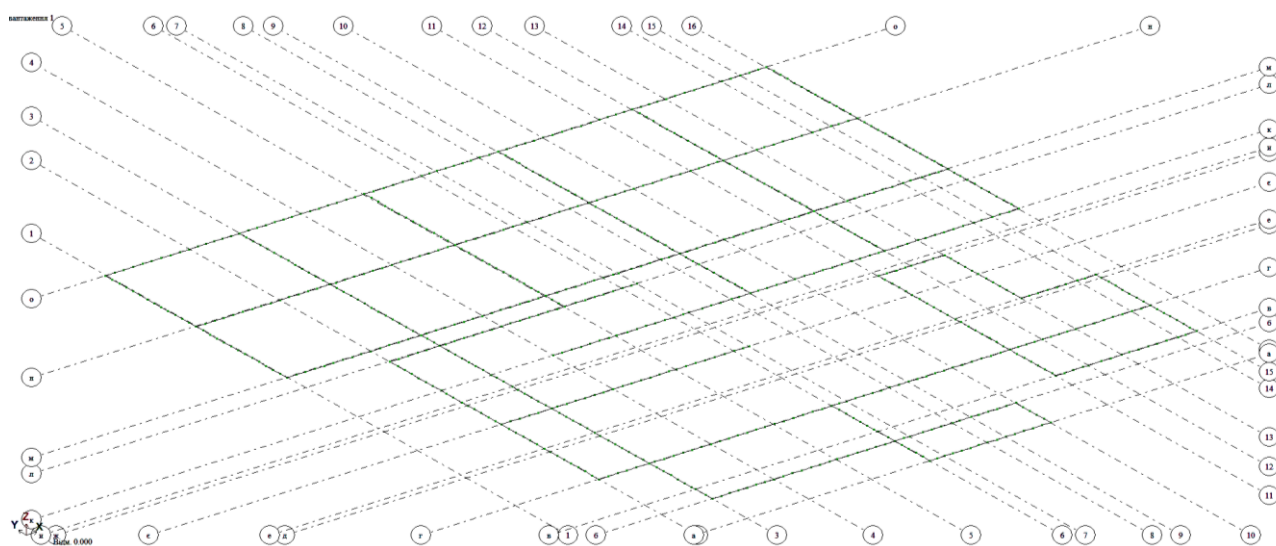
Стержневі елементи «прихованих балок» плити перекриття
